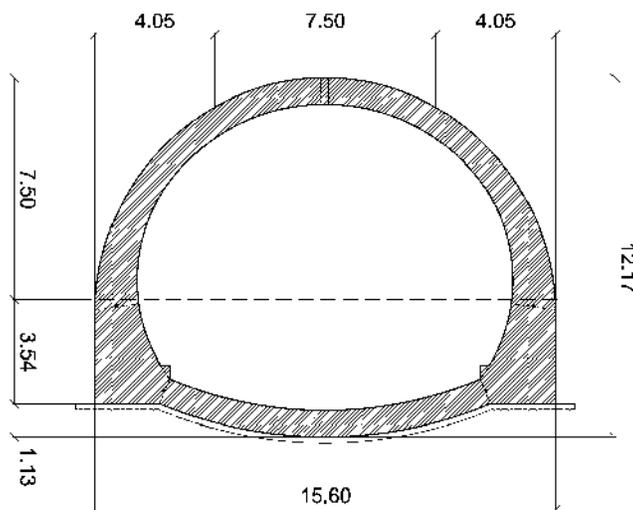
Imbocco lato Sarezzo, sezione tipologica portale
